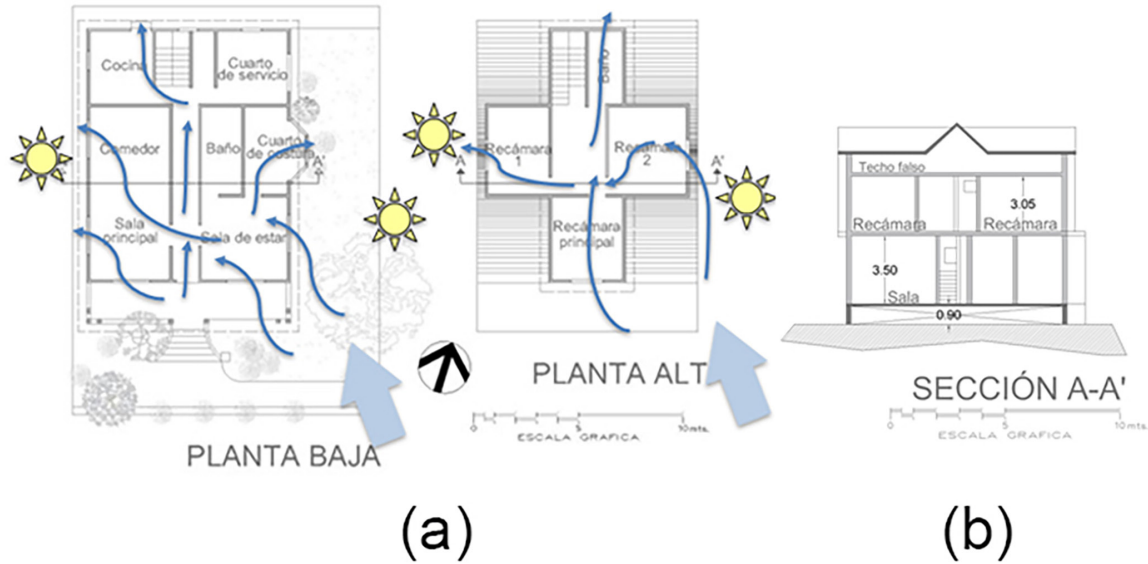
(a) Plantas arquitectónicas (b) Corte. Fuente. Elaboración de los autores
